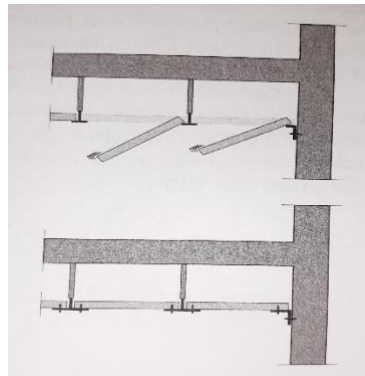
les faux plafonds doivent être suspendus solidairement aux planchers
